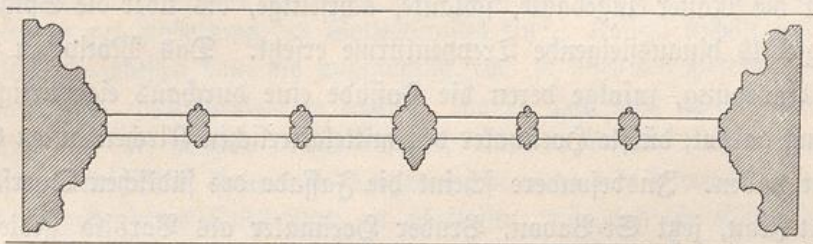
Gent. Jesuitenkirche. Profil des Mittelfensters der Fassade.
